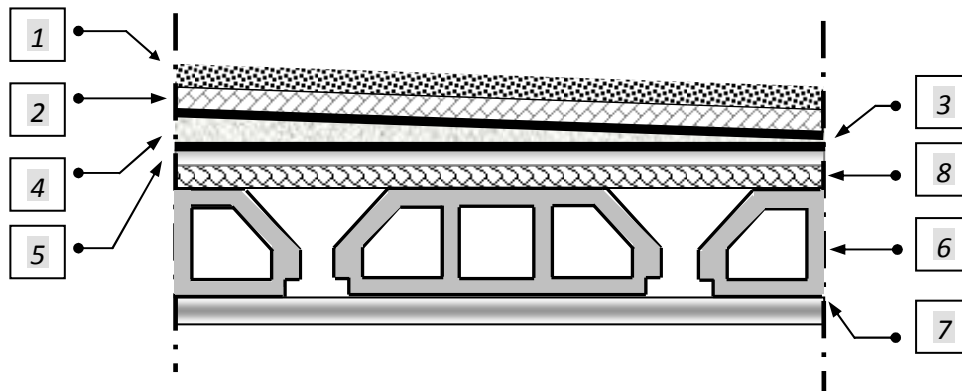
Coupe verticale du plancher terrasse à corps creux
